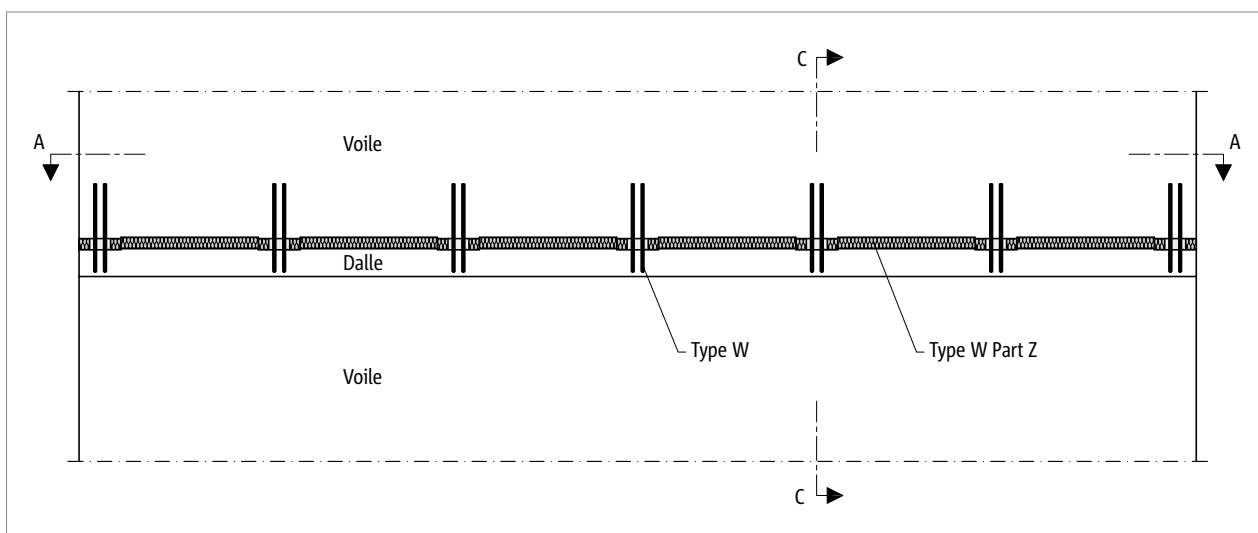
Schöck Sconnex® type W : raccordement entre la dalle et le mur montant - montage en pied de mur
